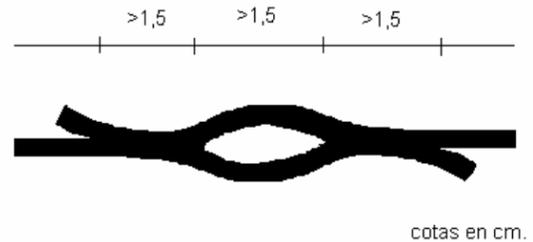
Dimensiones mínimas de la soldadura doble.
